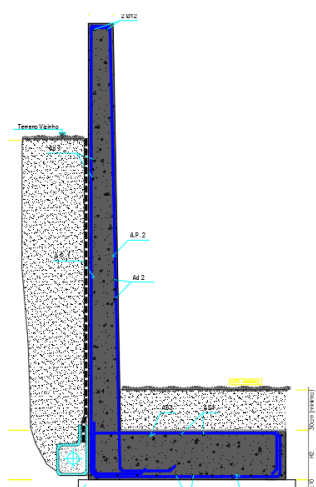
Estrutura modelada em Muros Em Consola De Betão Armado
